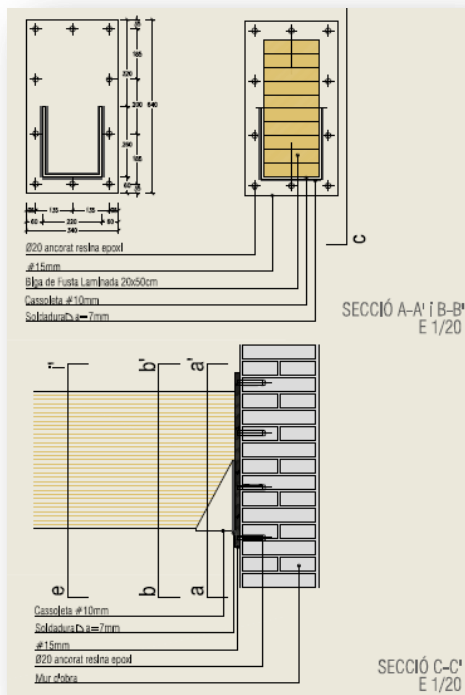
Detalle del procedimiento utilizado para transmitir la nueva carga en la estructura existente. En este caso el equipo de discentes propone realizar nuevas vigas metálicas conectadas mediante placas de anclaje a
